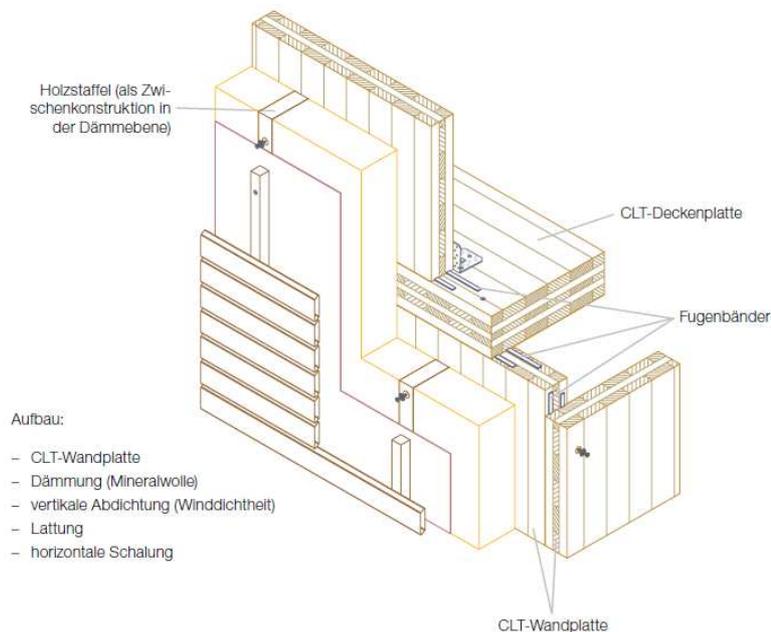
Prinzipieller Aufbau einer mehrlagigen Brettsperrholzkonstruktion⁷²
